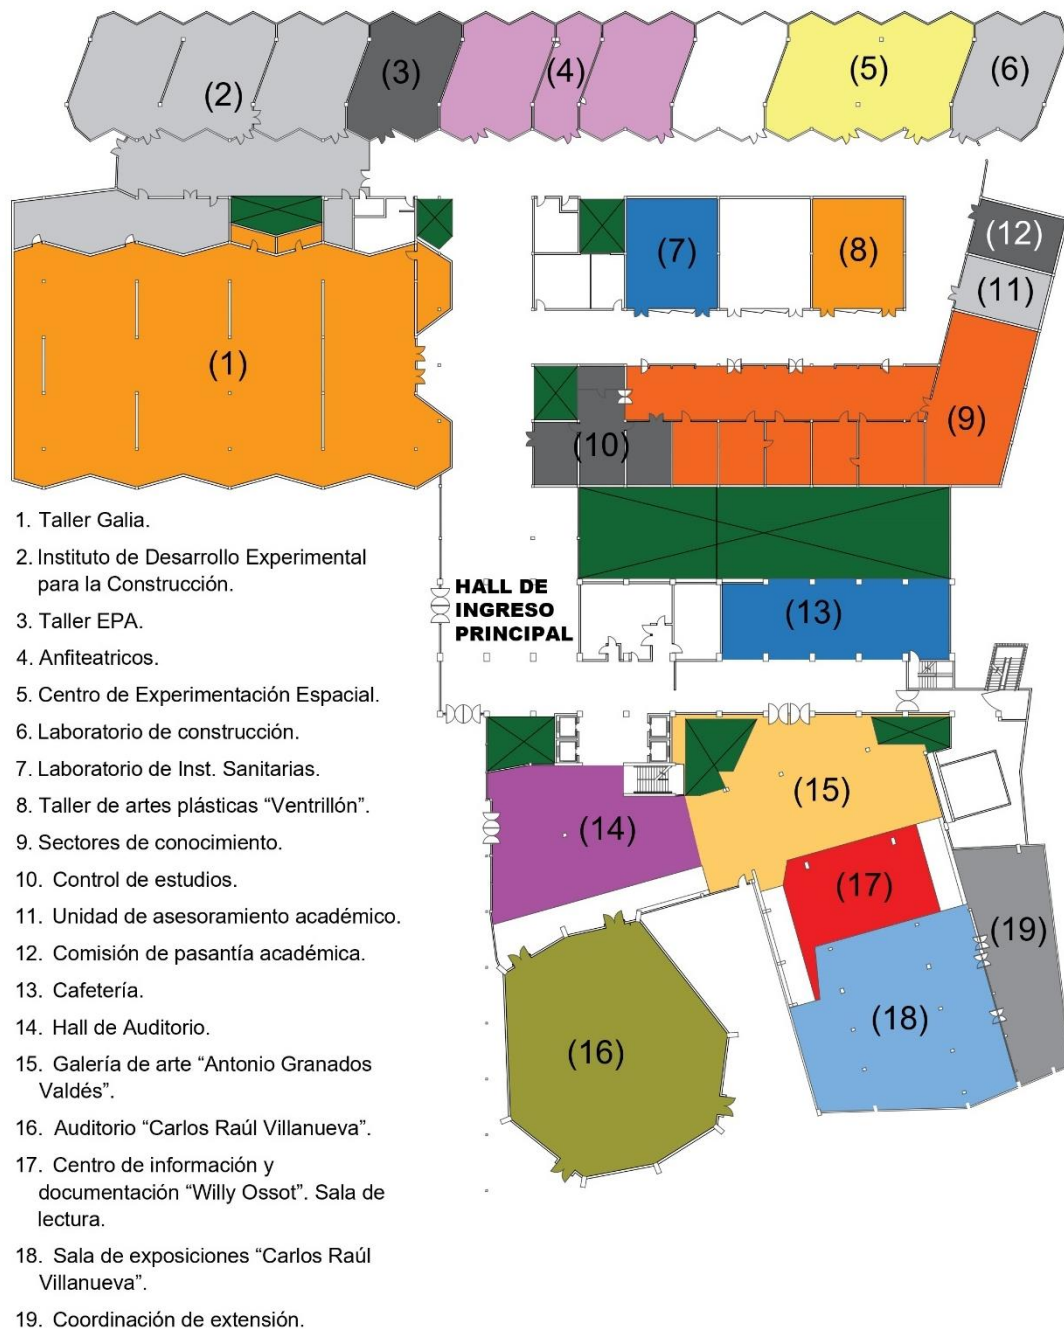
Planta baja del edificio de la FAU-UCV, Caracas. (Fuente propia adaptada de la página de la FAU-UCV).
